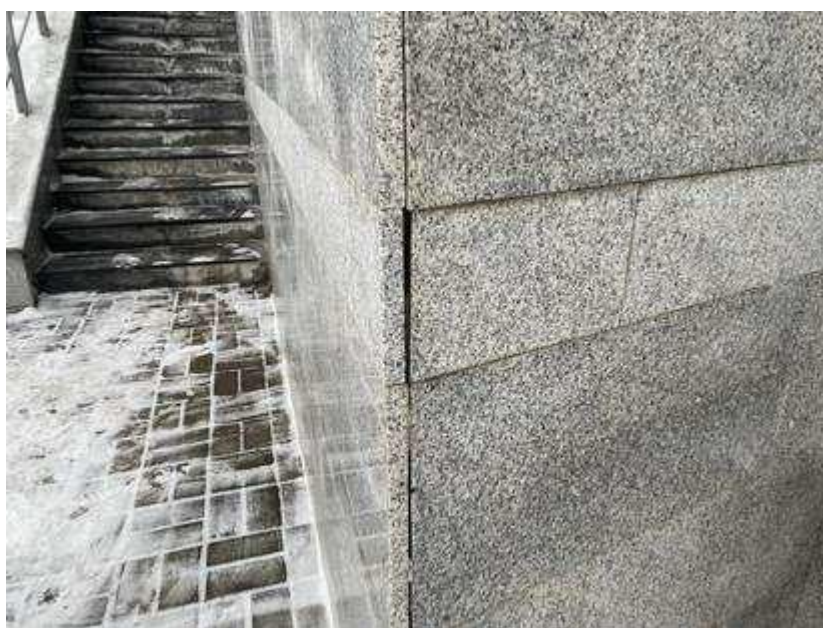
Неплотное прилегание плиток на площади до 50 % облицовки. Раствор основания разрушен.
